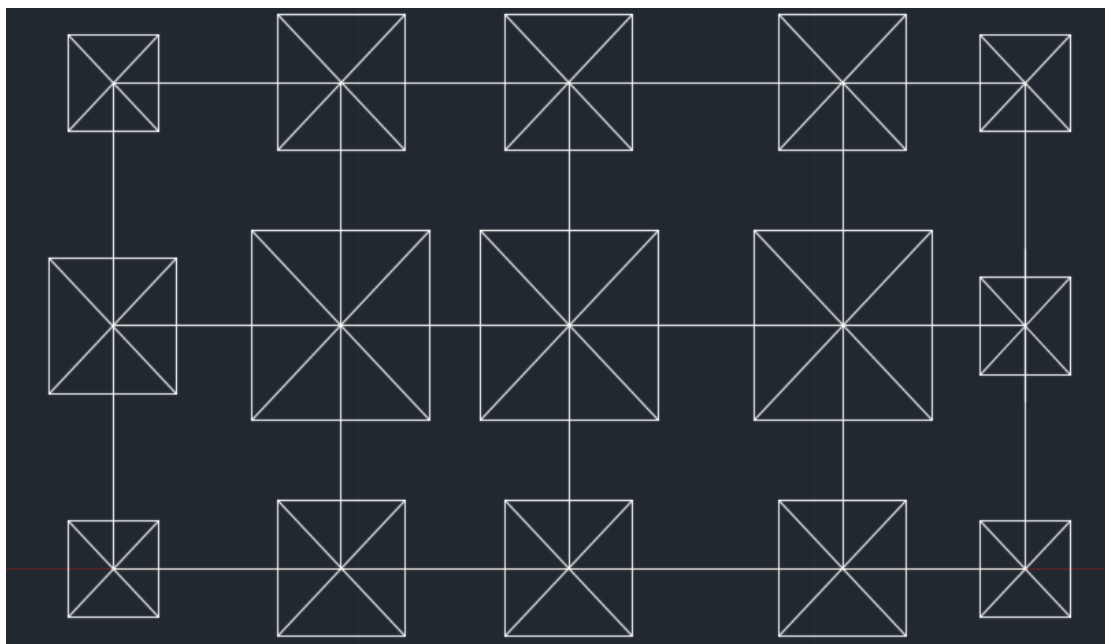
22. Esquema en planta para la solución por zapatas. Elaboración propia.
